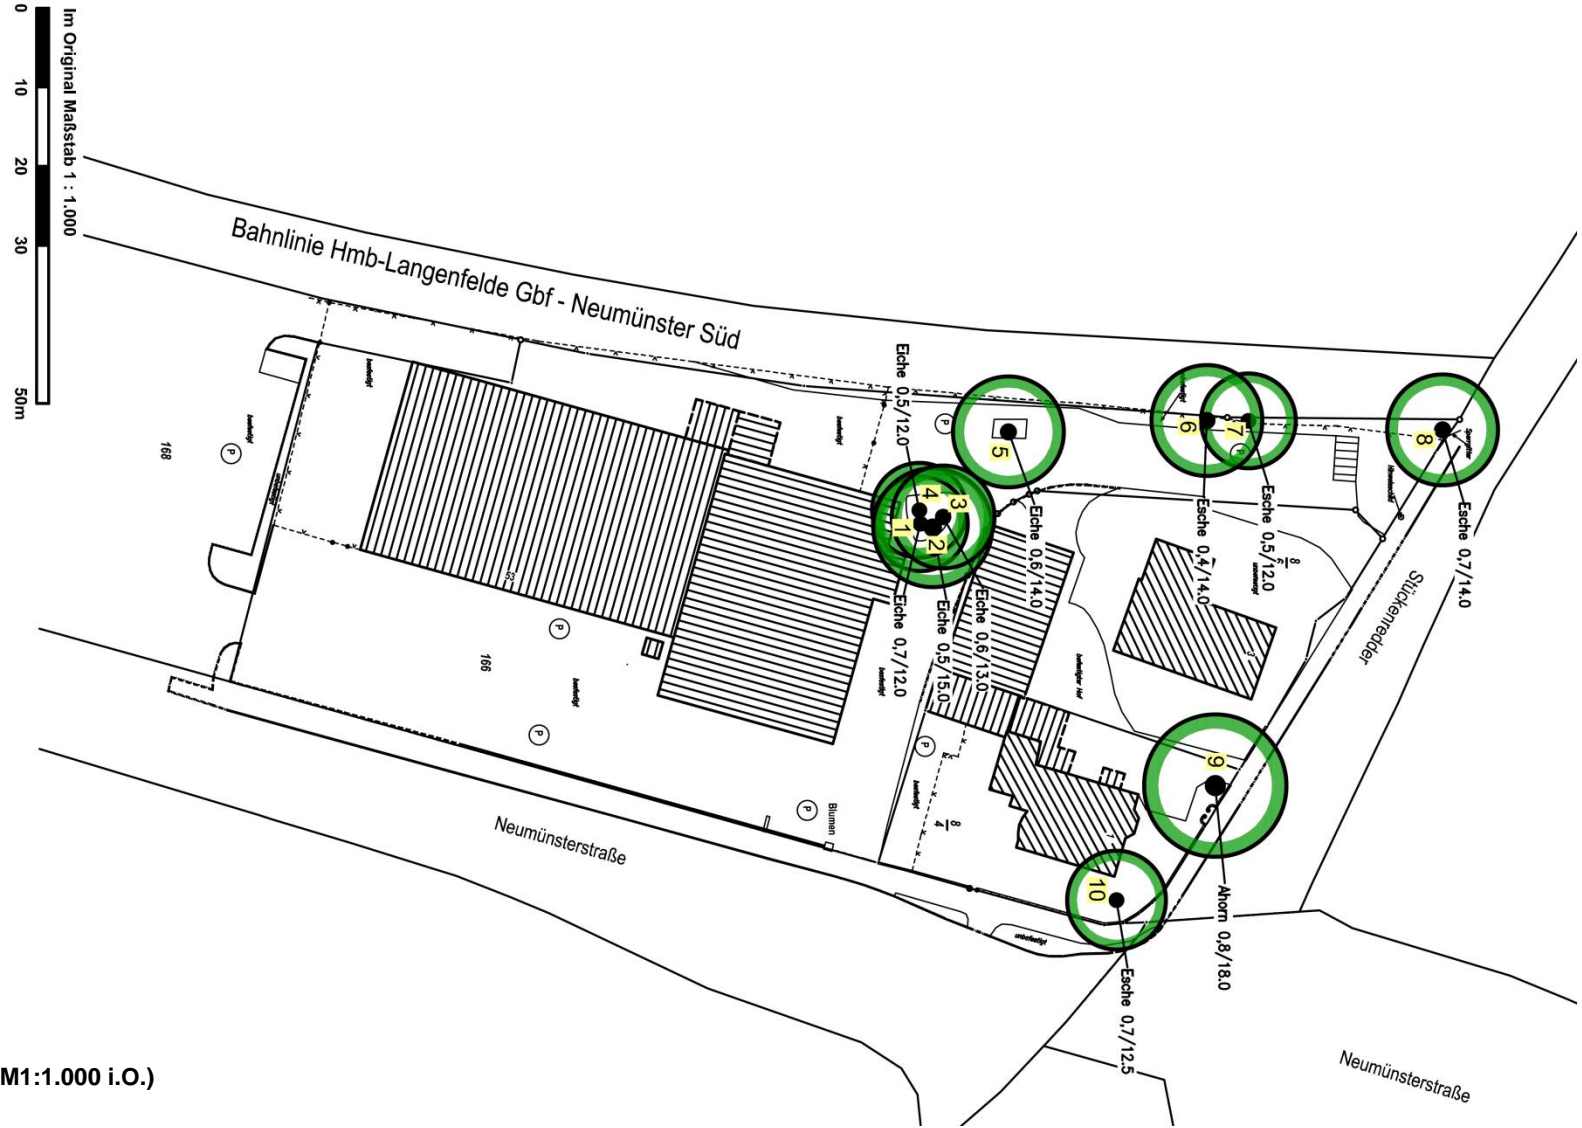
Lageplan Bäume (M1:1.000 i.O.)
